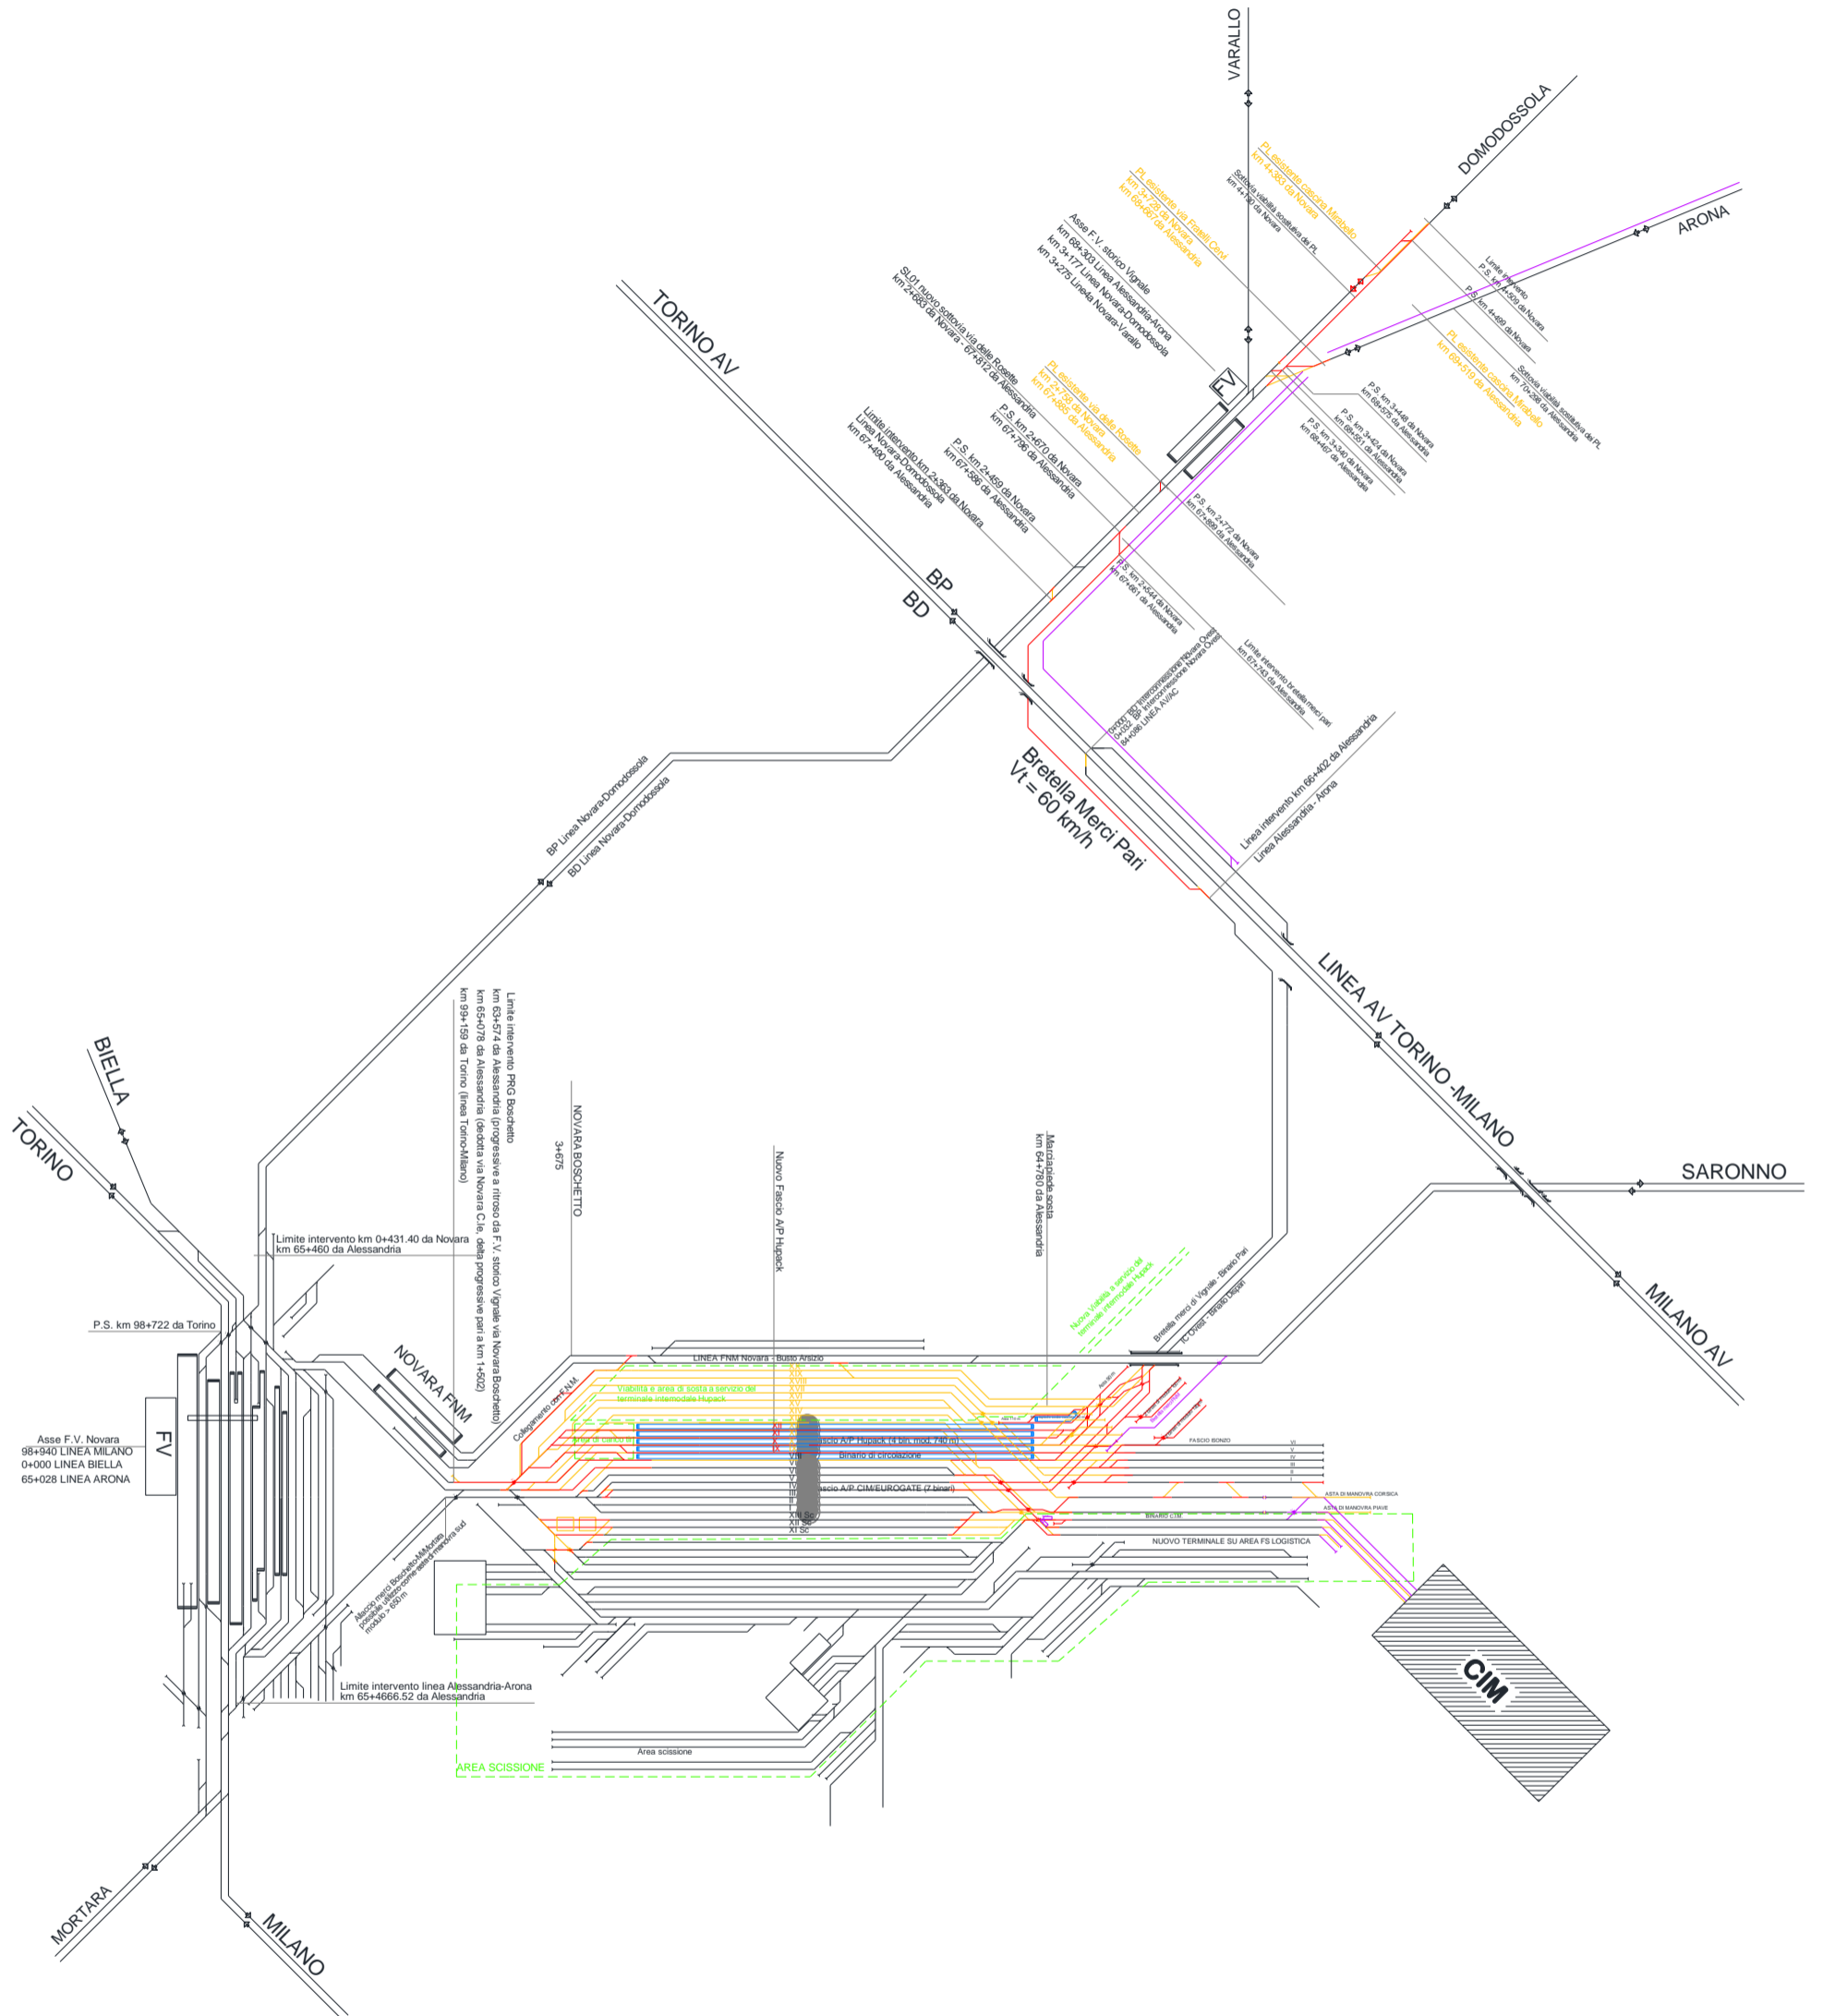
LAYOUT SCHEMATICO DI PROGETTO NOVARA BOSCHETTO
